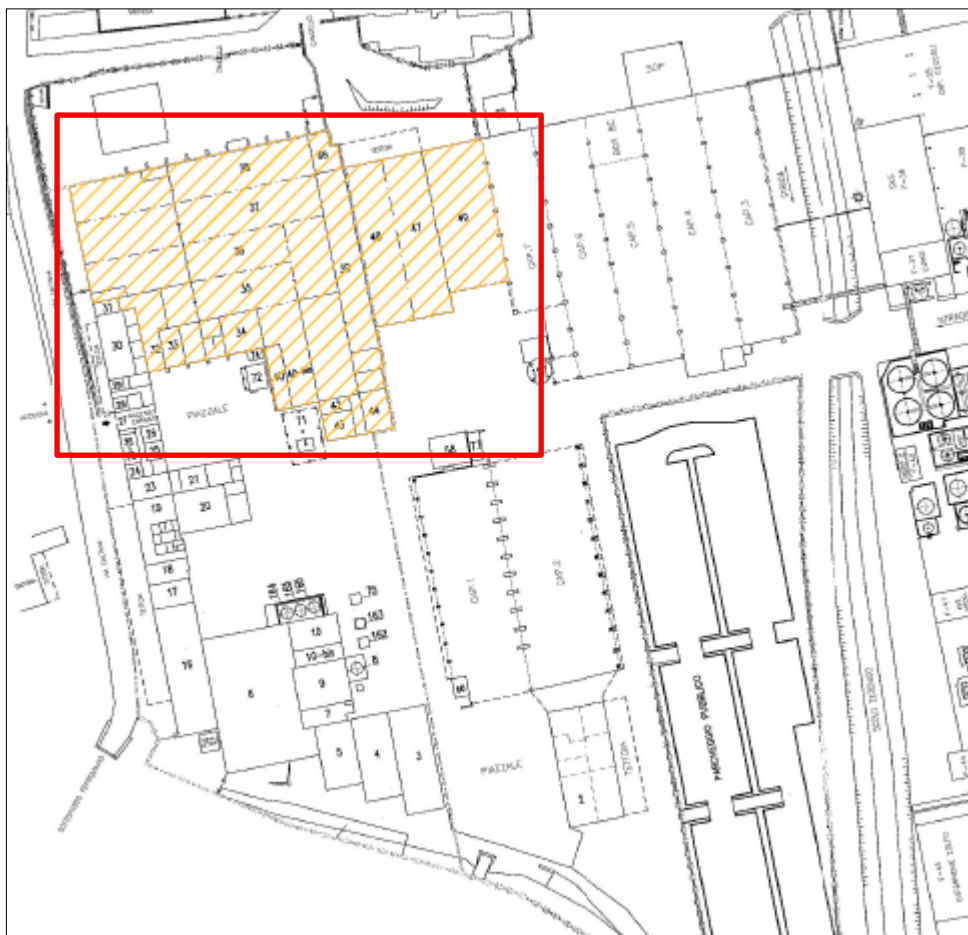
Estratto della planimetria dello stabilimento con individuata la configurazione esistente dei magazzini
